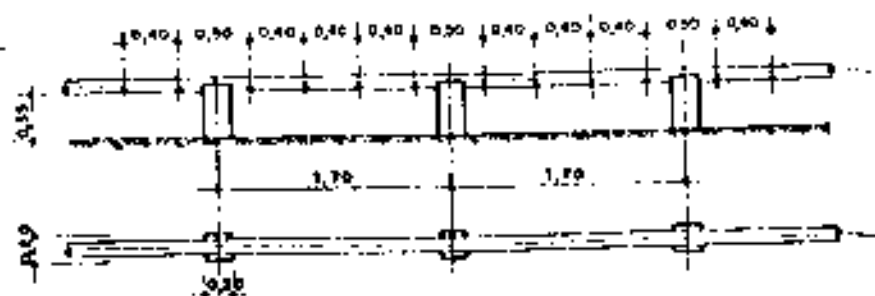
Detalle das pilinas de tubulação de PVC sobre o terreno
